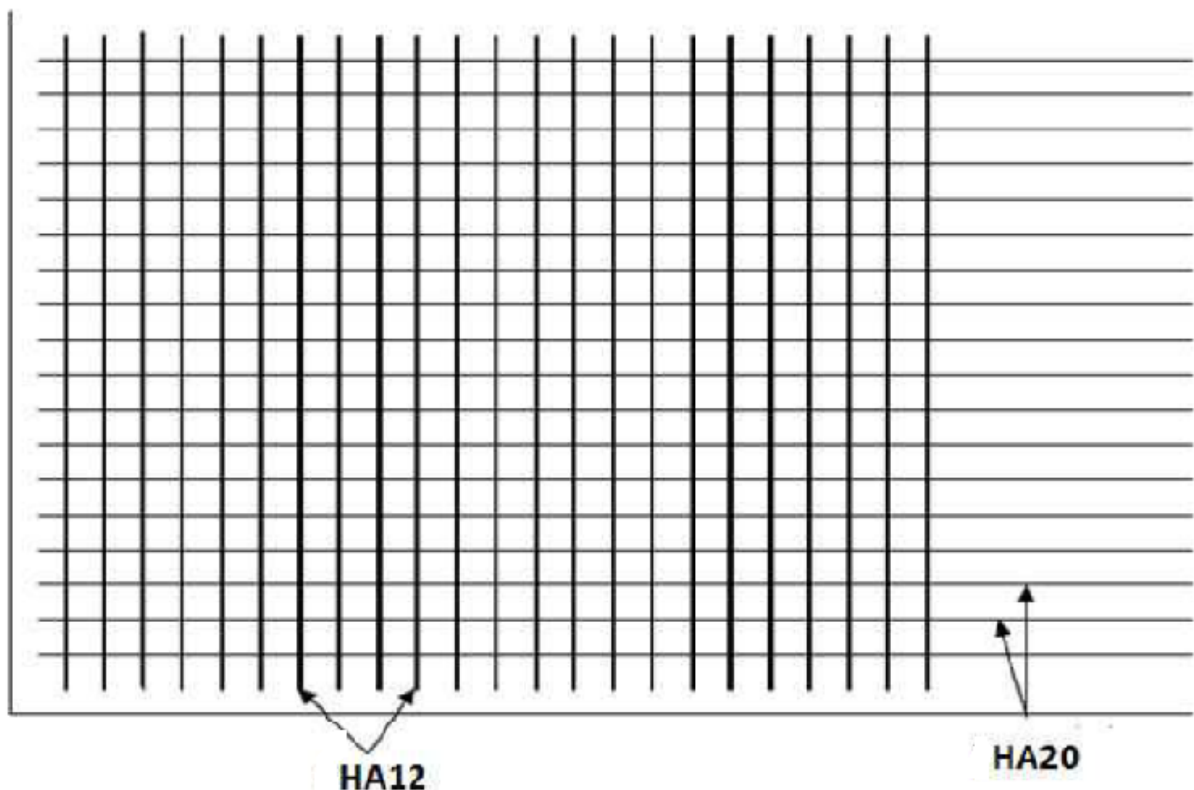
Ferrailage longitudinal et transversal de la nappe supérieure
